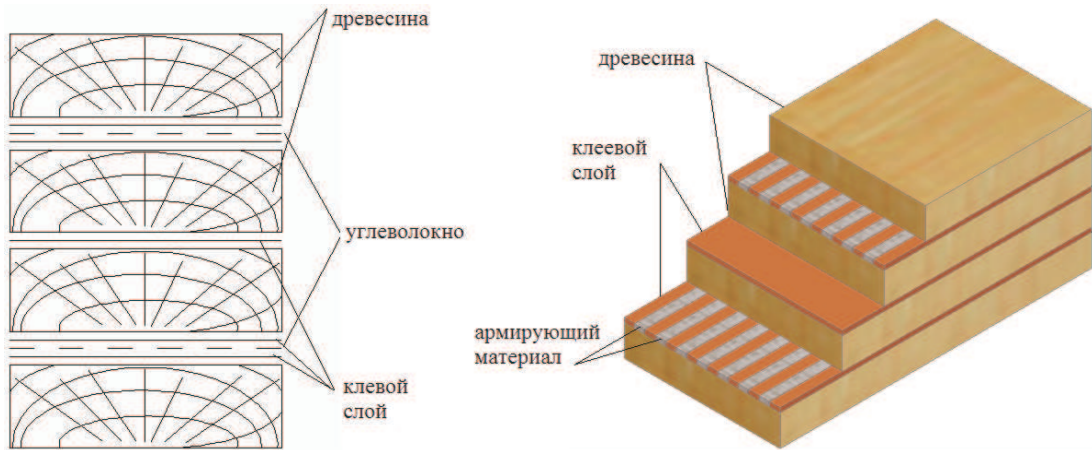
Модель фрагмента клееной балки с послойным полосовым армированием конструкции углеволокном.
